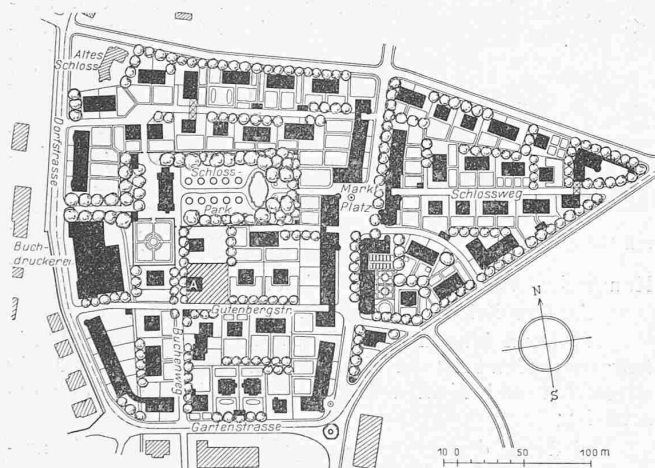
Lageplan zur Ueberbauung des «Schlossgutes» in Bümplitz. Masstab 1:5000.
